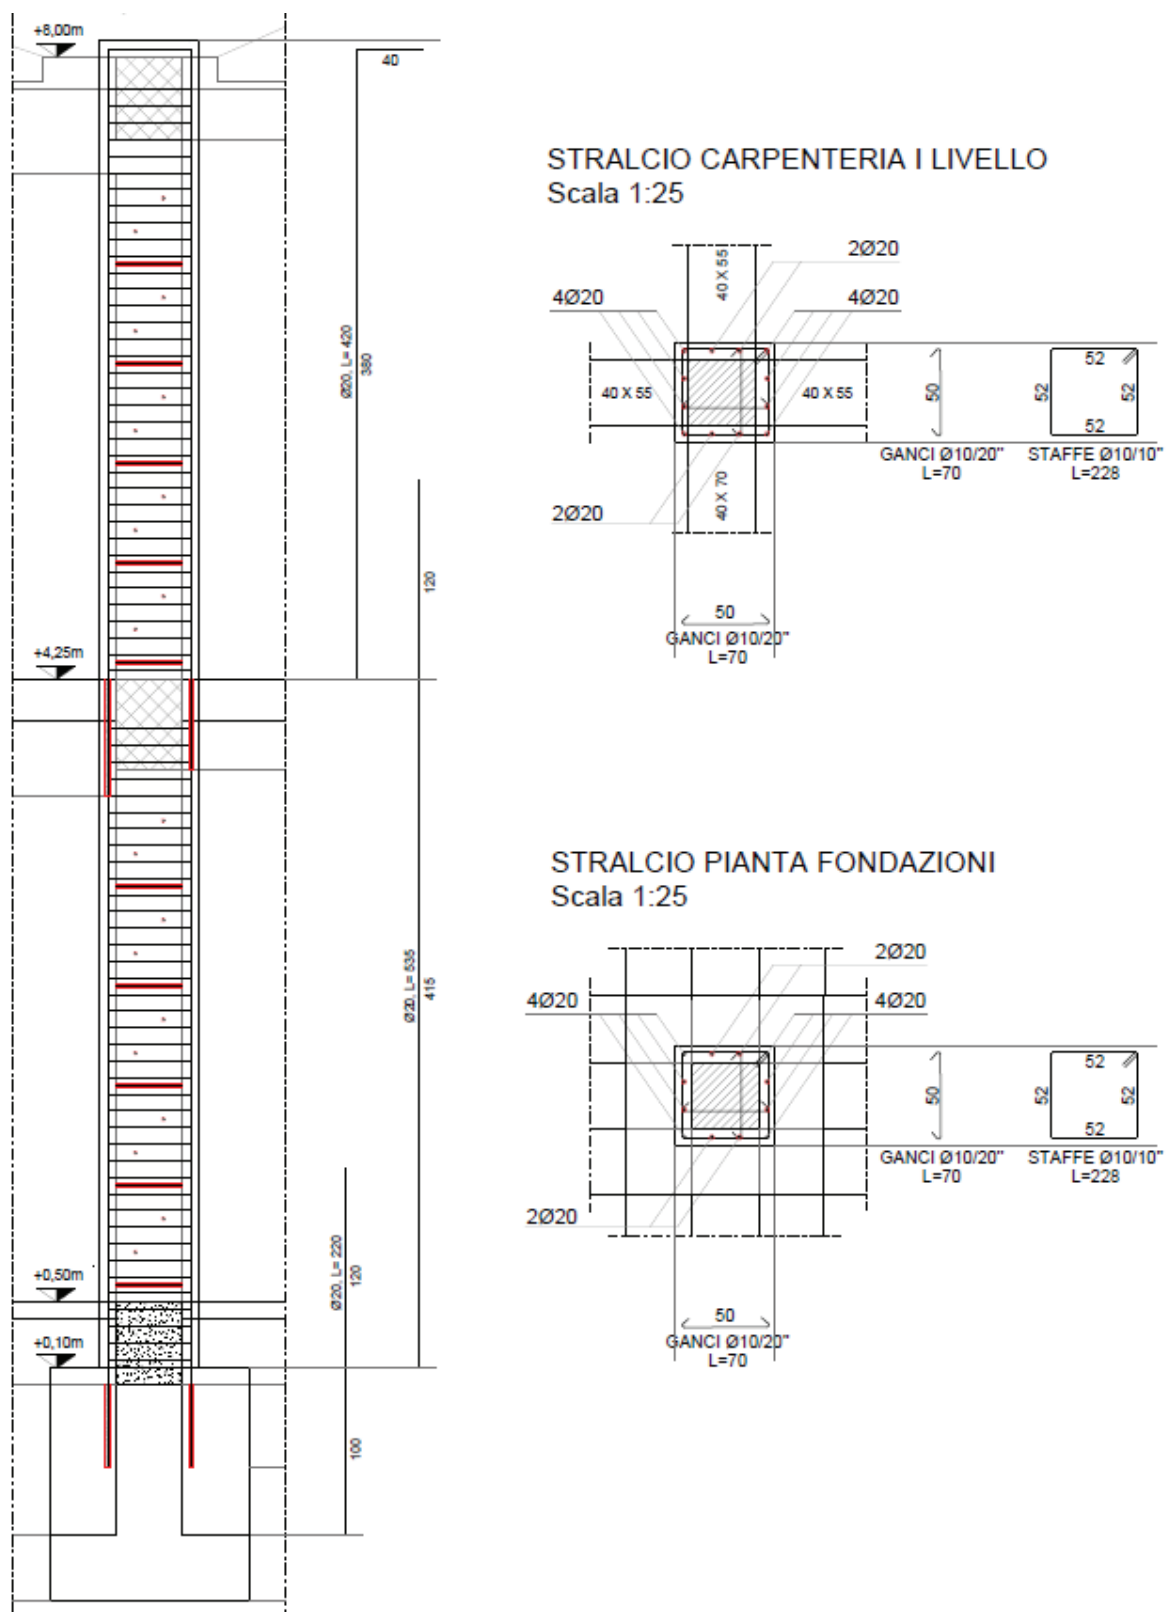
Intervento in elevazione – Ringrosso Pilastri
